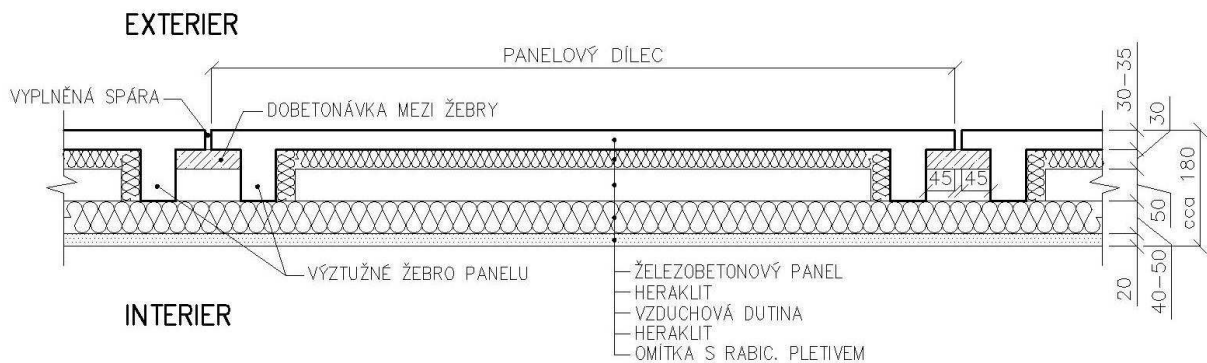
Příklad skladby obvodového pláště z prefabrikovaných panelů (18)
